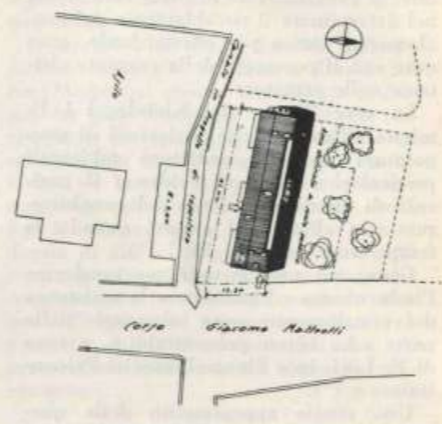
Planimetria: Motto "Nord-Sud A".
